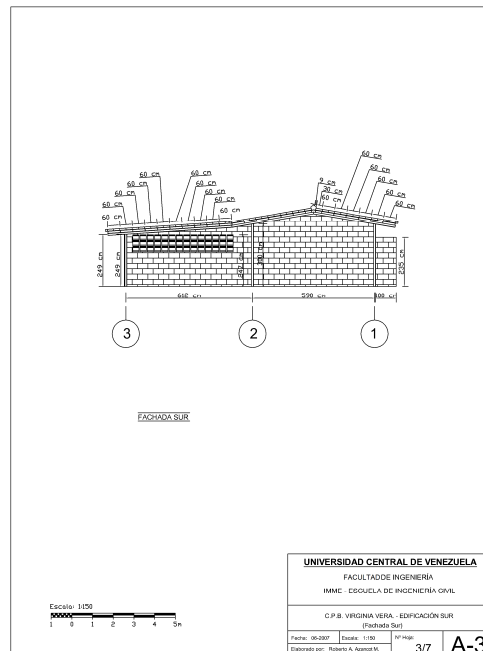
Plano A3: Plano Arquitectónico de la Fachada Sur
